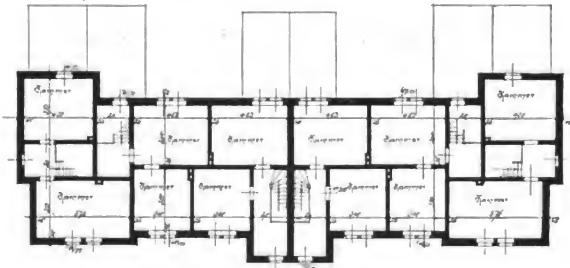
Grundriß zu Abb. 101. Dachgeschoß.
